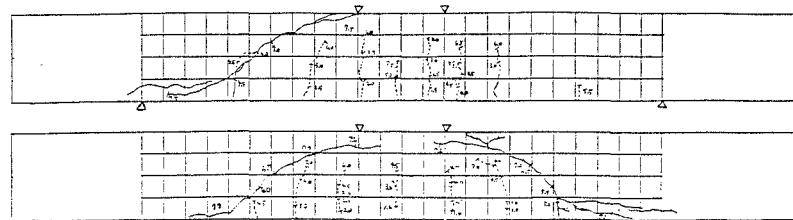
ひび割れ性状 [a/d=3.1] (上 : 碎石RC, 下 : 再生RC)
